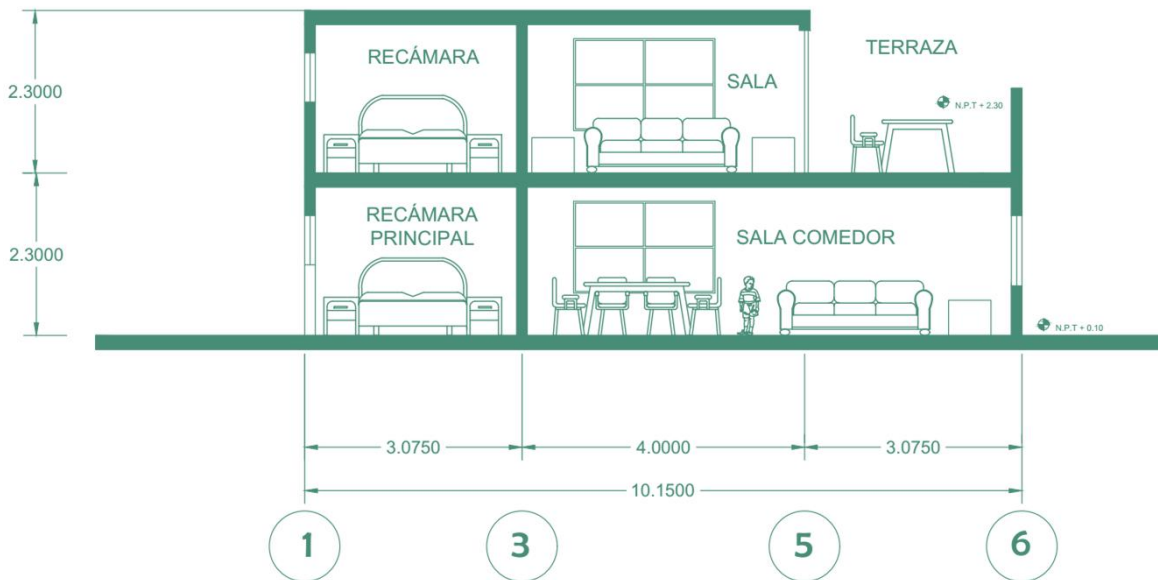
Corte longitudinal B-B'. Fuente: Elaboración propia.
